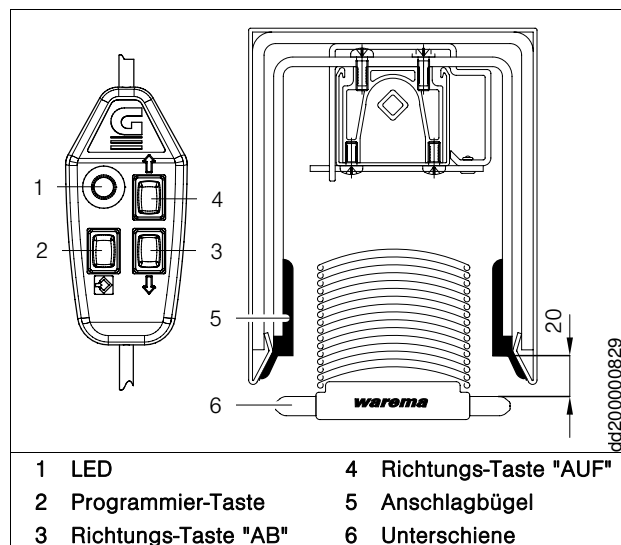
Motor mit Einstellkabel (Art.Nr. 616226) einlernen
